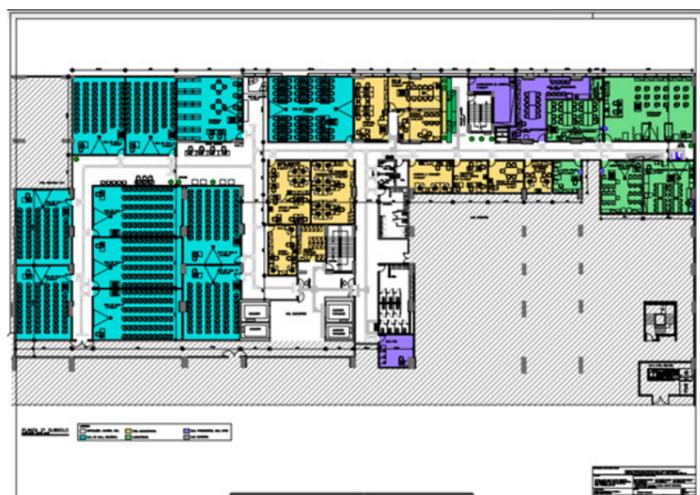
Planta fase 2 – 2º Subsolo – Faculdade Santa Casa BH
